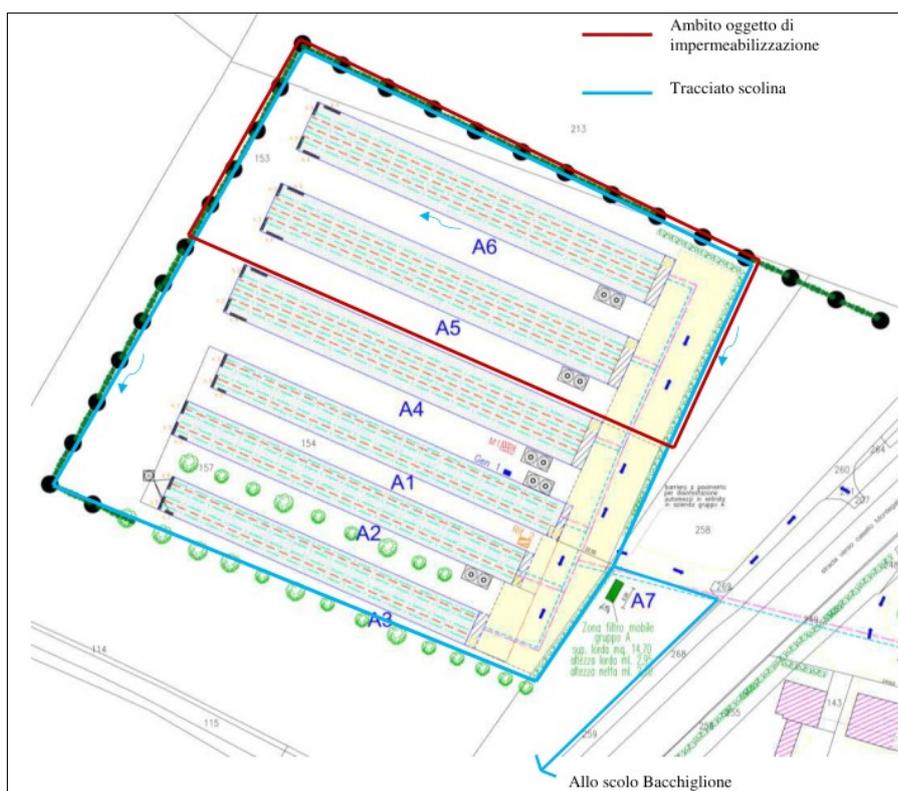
schema estratto dalla tavola 7 di progetto con l'ubicazione della scolina (Valutazione di Compatica Idraulica redatta dalla dott. geol. Silvia Daleffe)
